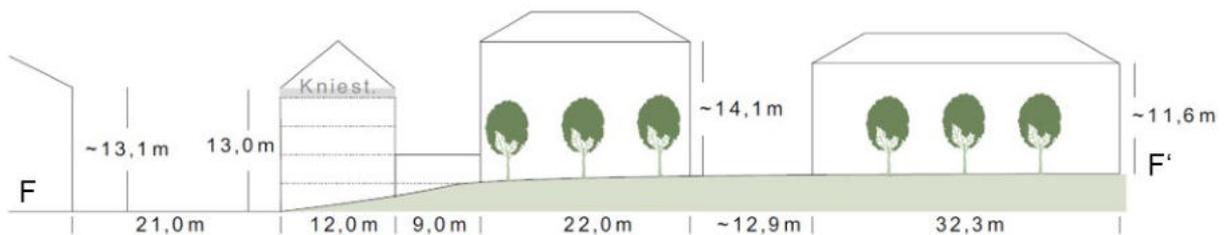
Entwurfsvariante Baufeld West: Fortführung der Bestandsbebauung, Zeilenstruktur Landauer Straße Schnitt F-F' (o.M.)
